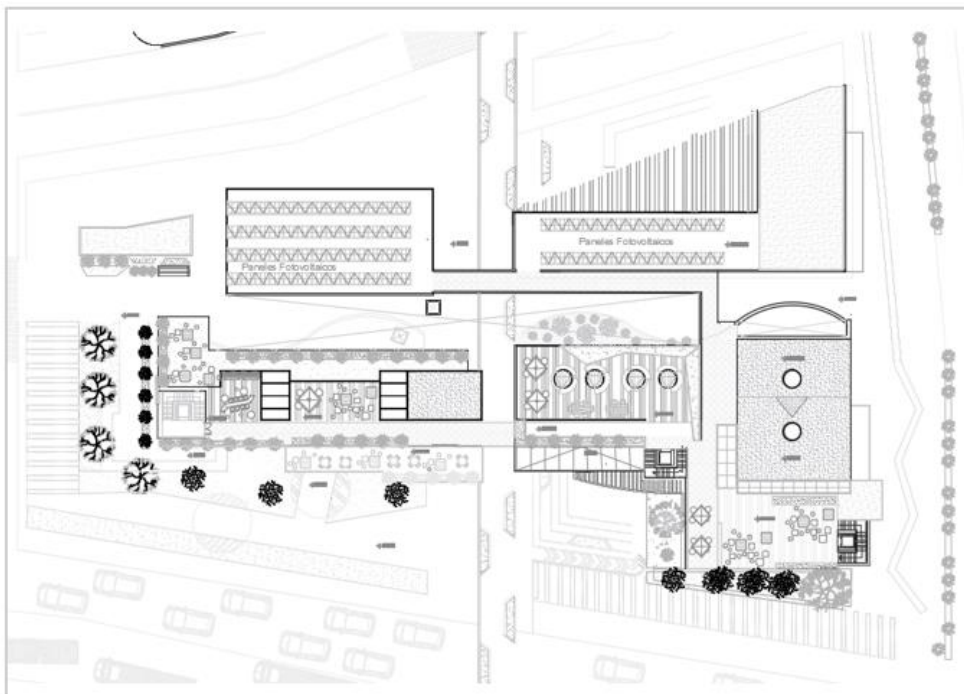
Propuesta planta cubiertas. Autoría propia (2020)
